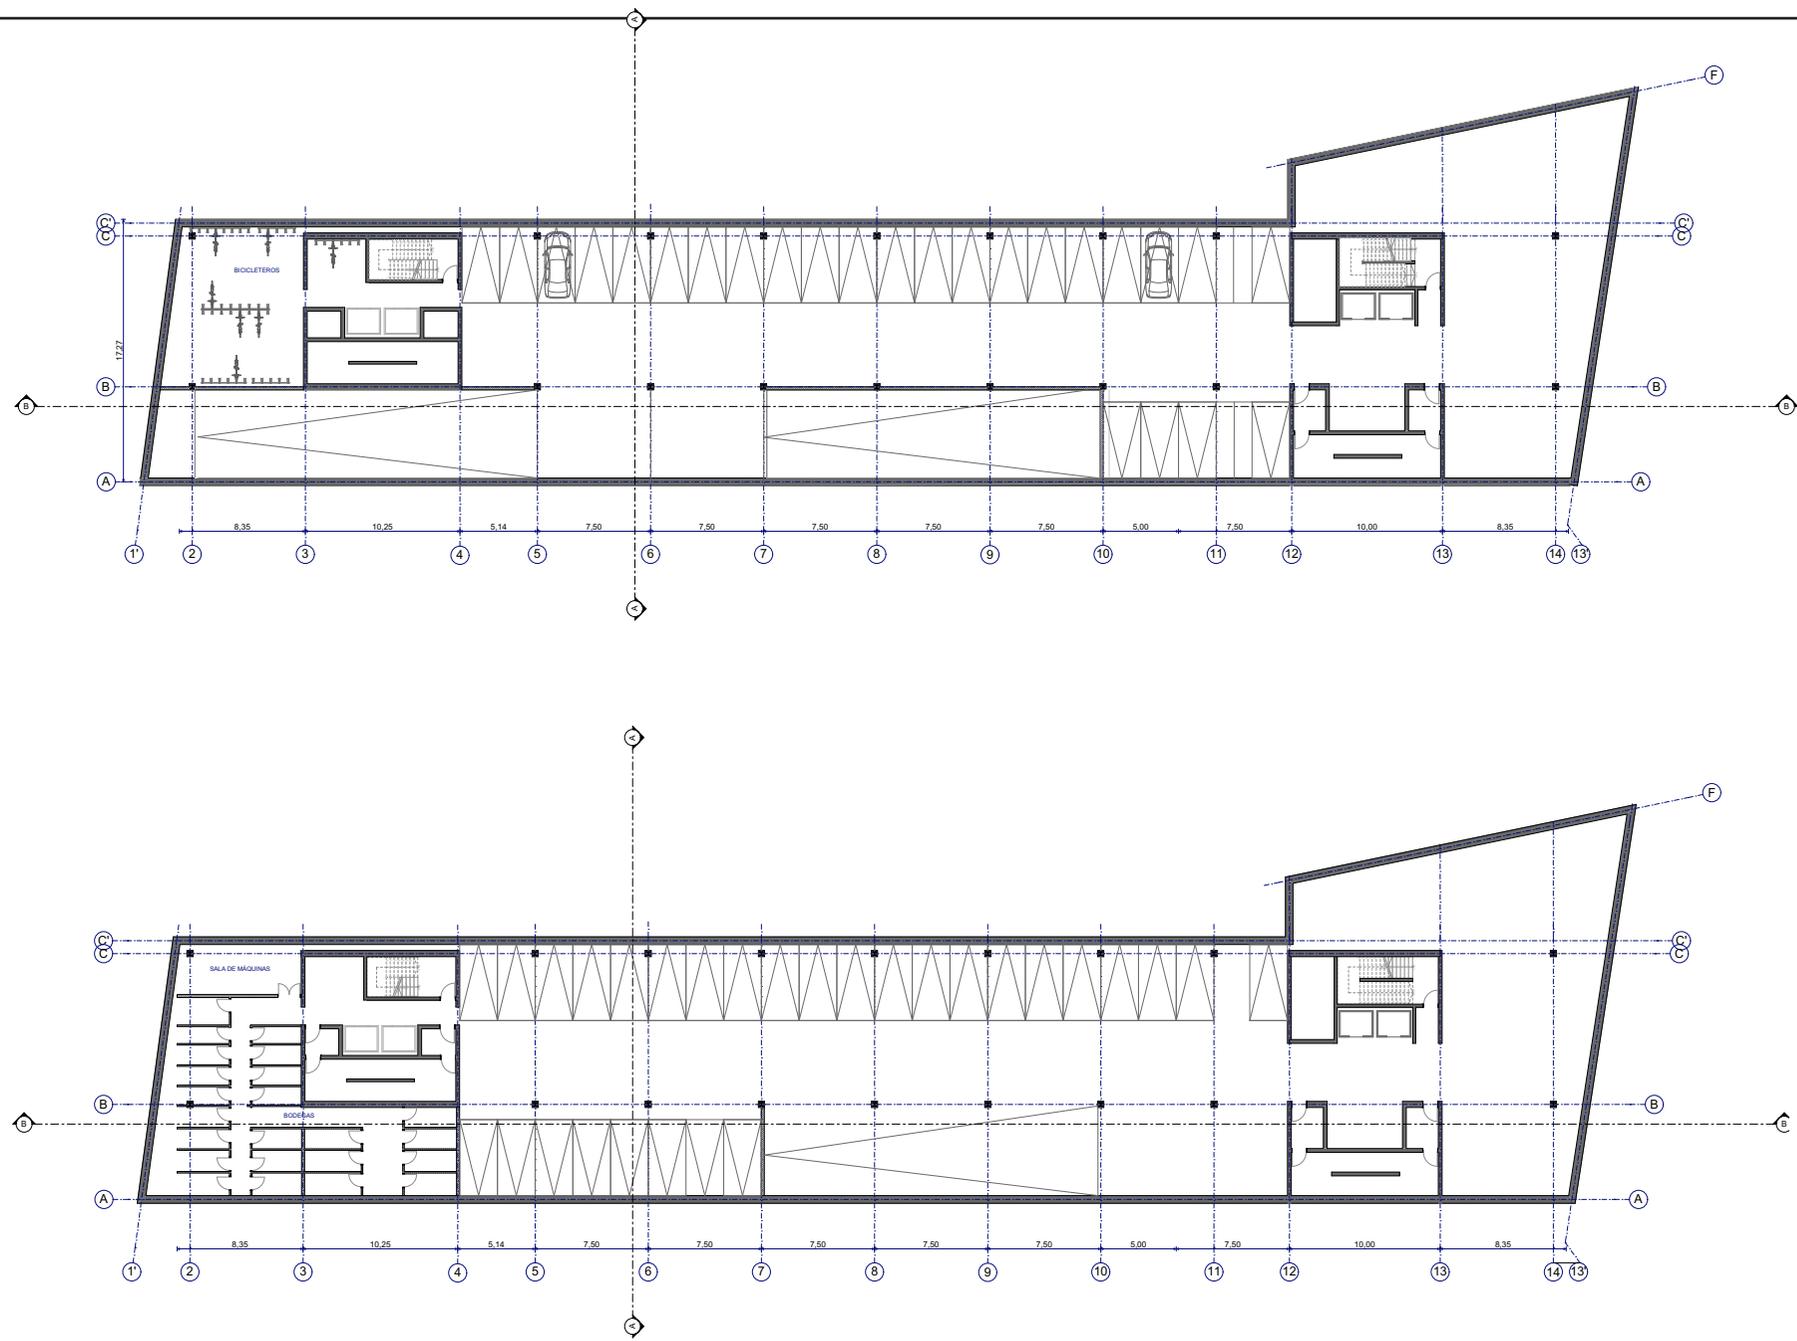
Planta cuarto nivel. Fuente: Elaboración propia
